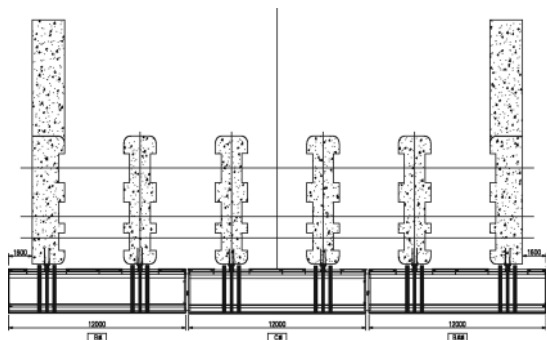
1#、3#、5#、7# 拦污栅爬模平面布置图
